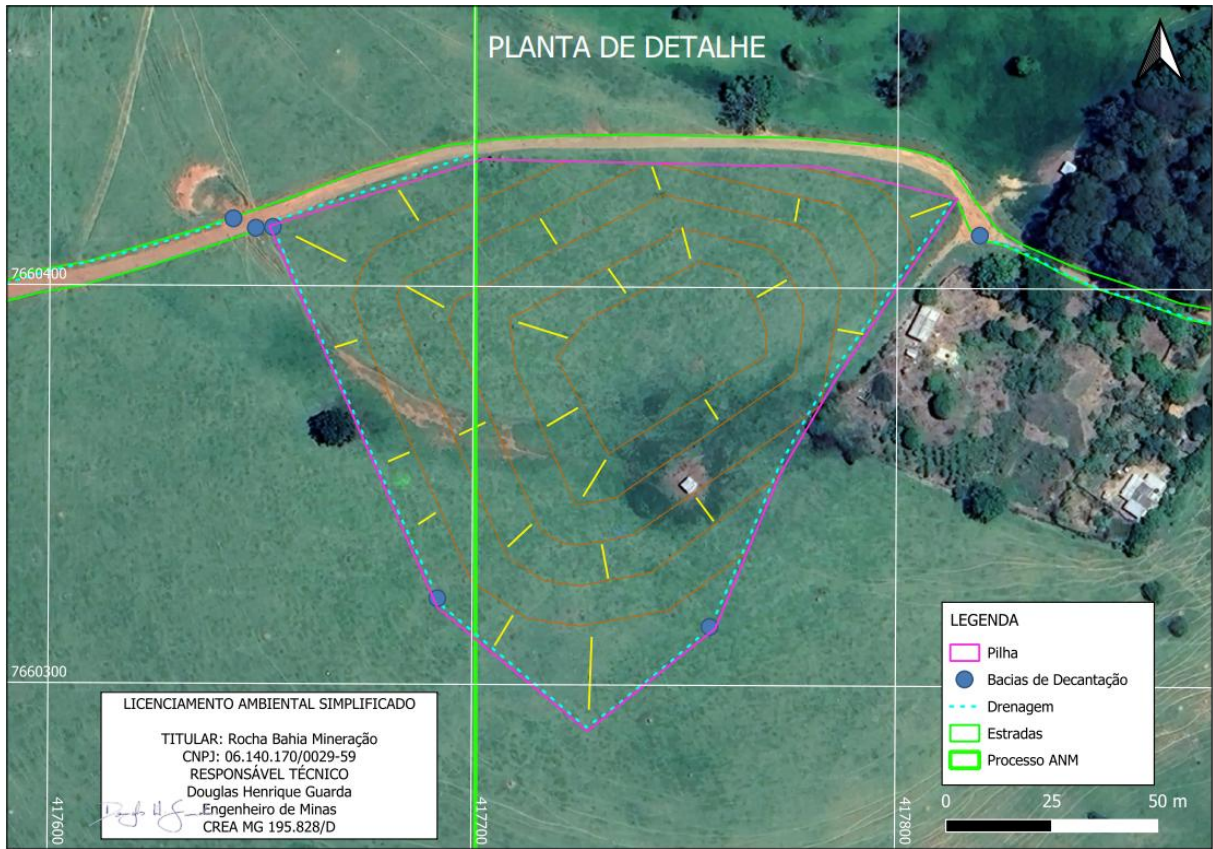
Planta de detalhe da Pilha de rejeito/estéril. Fonte: RAS
